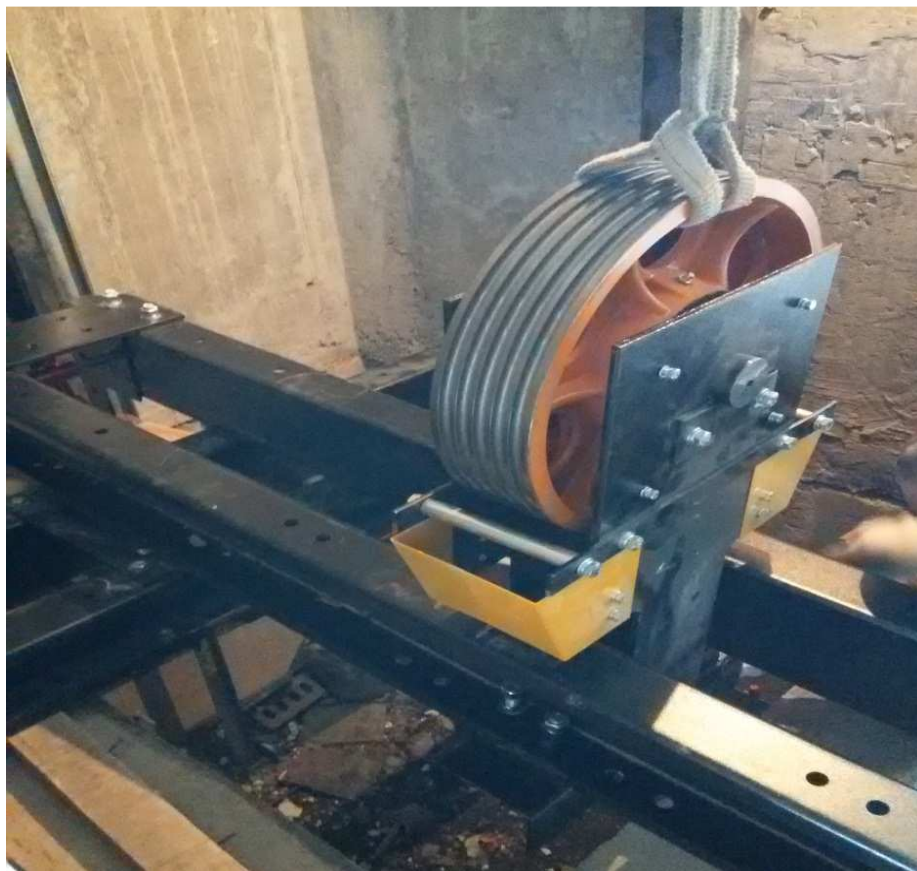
Монтаж верхней балки каркаса и шкива кабины
